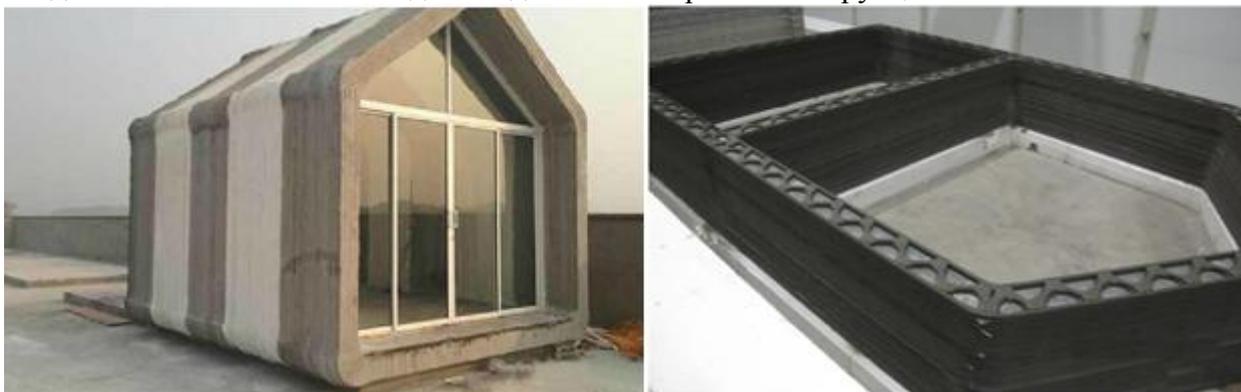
Жилые здания, возведенные компания WinSun Decoration Design Engineering Co. [2]
